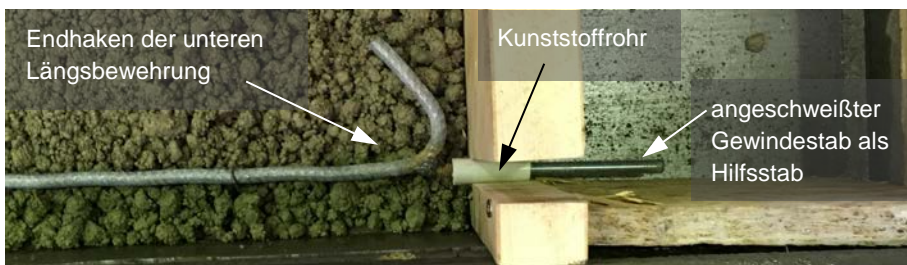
Bewehrungsstab mit Endhaken und angeschweißtem Hilfsstab
